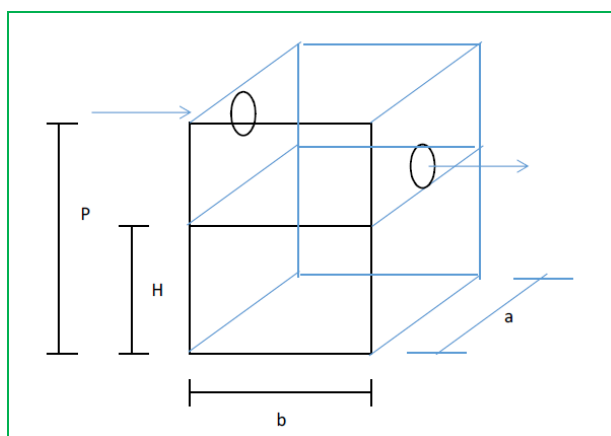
Detalhe Caixa de Gordura e dimensionamento.
